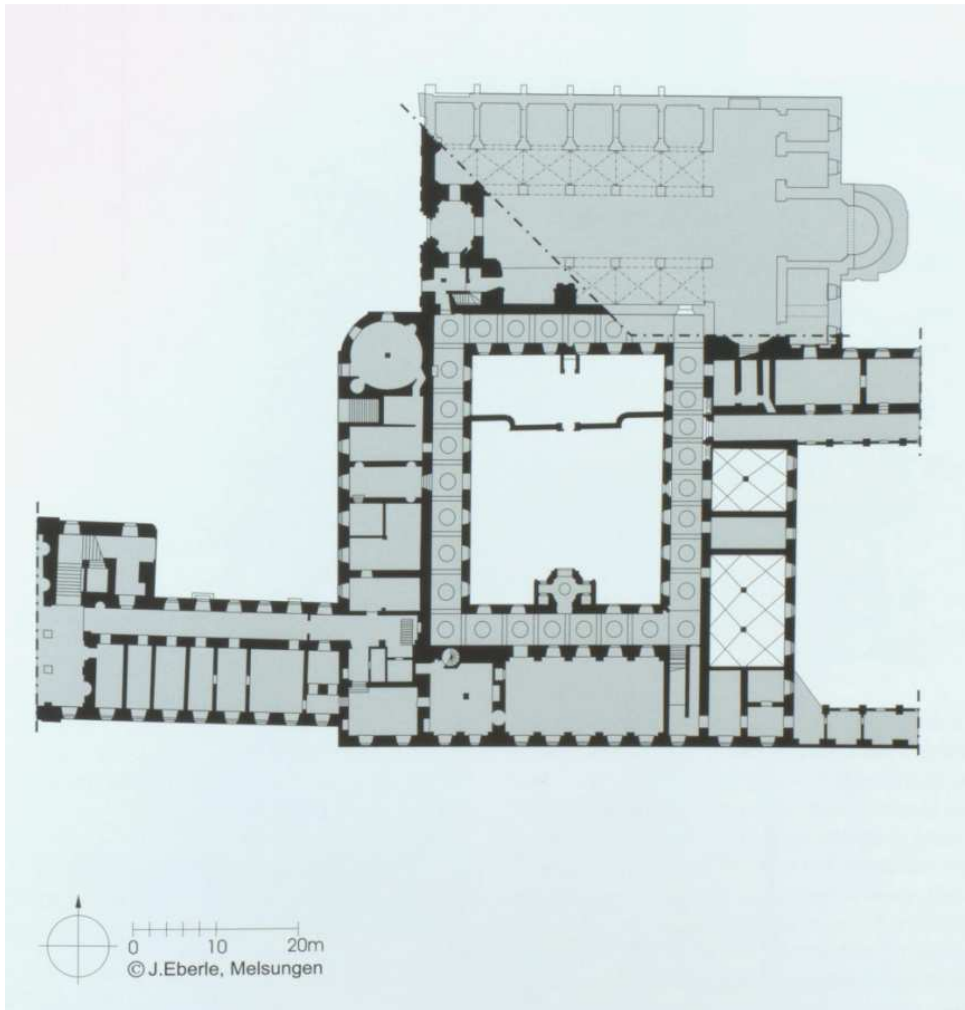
Stift Wilhering, Grundriss, Jürgen Eberle
